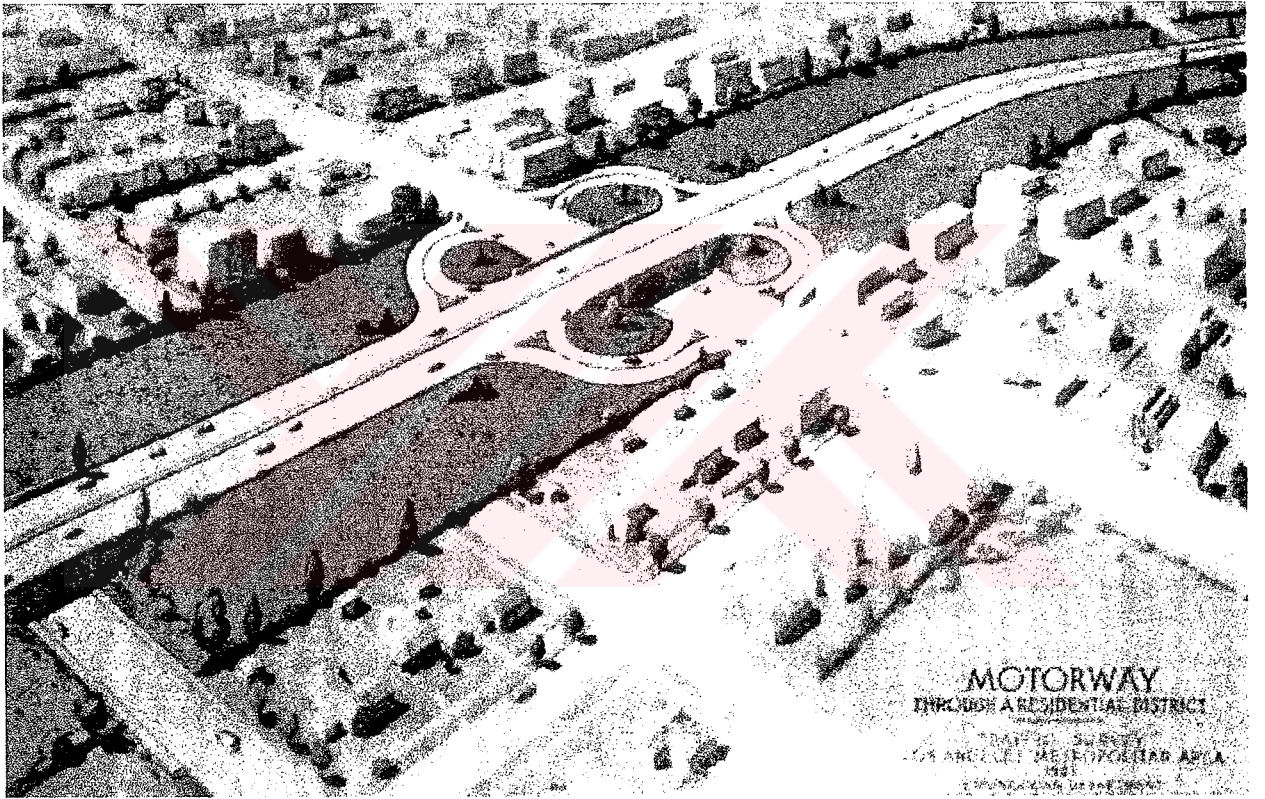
Los Angeles için Ana Caddeler Trafik Planı'ndan bir kavşak detayı, 1924 (Wachs, 1998)
